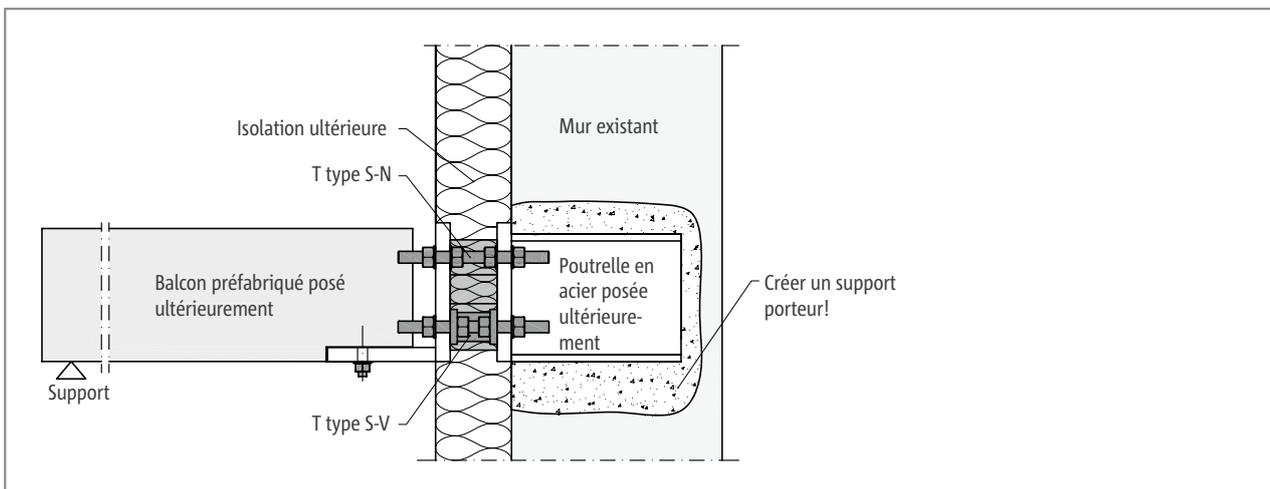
Schöck Isokorb® T type S-N et T type S-V : balcon préfabriqué soutenu posé ultérieurement ; raccordé à des poutres en acier posées ultérieurement avec remplacement
